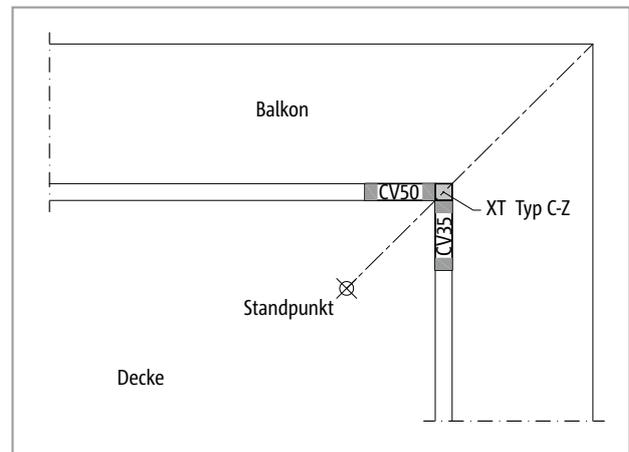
Schöck Isokorb® XT Typ C: Betondeckung wählbar: Hier CV50 links vom Standpunkt, Betondeckung CV35 rechts vom Standpunkt
